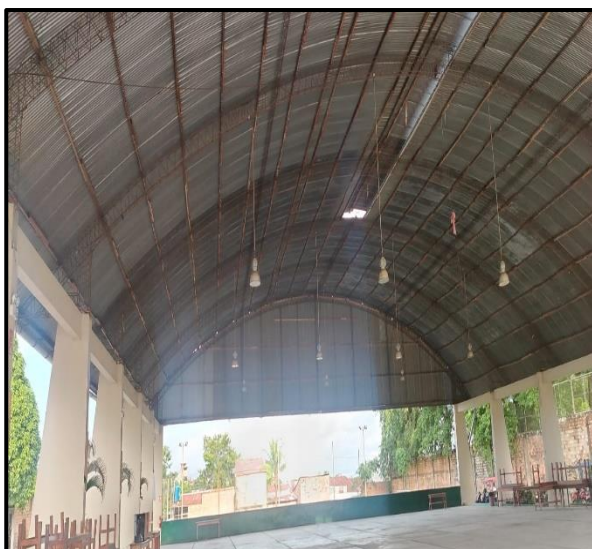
y 18: Vistas Fotográficas del segundo piso del módulo.
